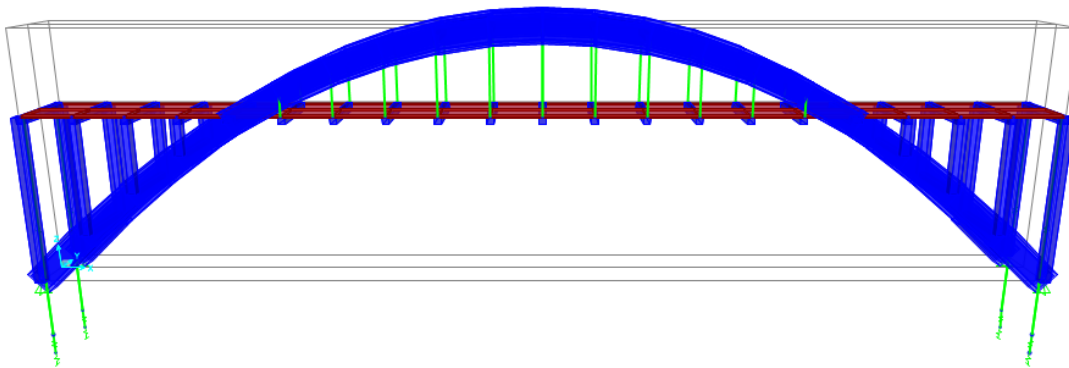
Variante 2. Fuente: elaboración propia (2022)
